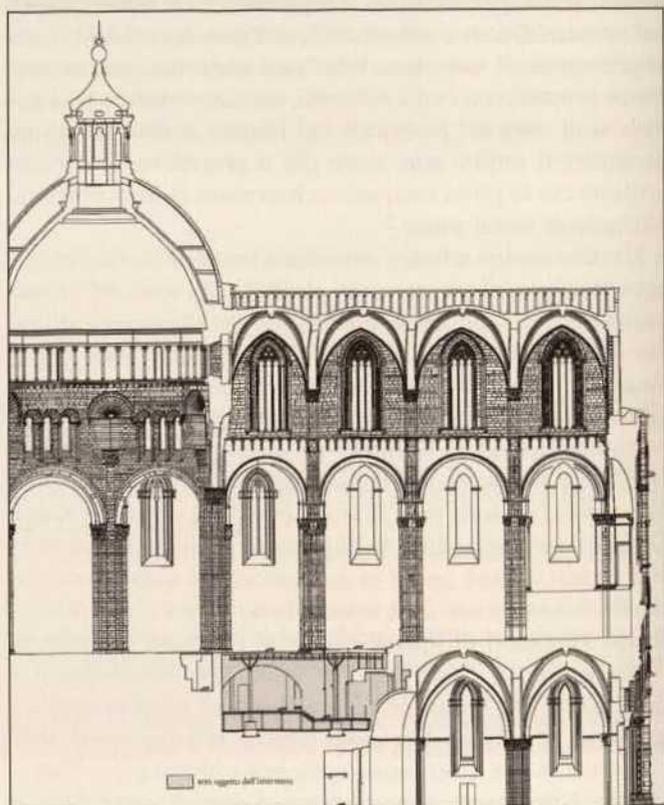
Siena, cattedrale, sezione longitudinale del coro, disegno della Messbildstelle di Dresda (particolare) con individuazione dell'area dell'intervento / Kathedrale, Längsschnitt der Messbildstelle Dresden durch den Chor (Ausschnitt) mit Kartierung des freigelegten Bereichs (Sotto il duomo di Siena, 2003, 207).
